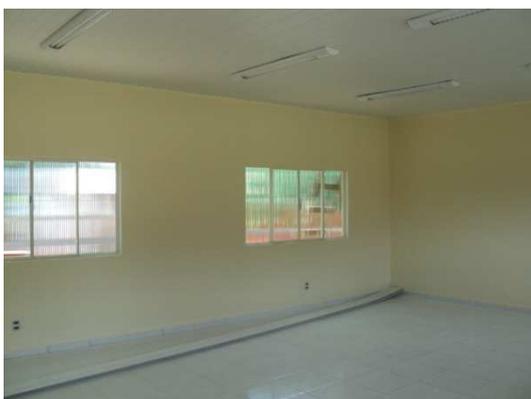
Construção Anexo Escola Barão do Rio Branco em F. do Abunã - 25/10/11
